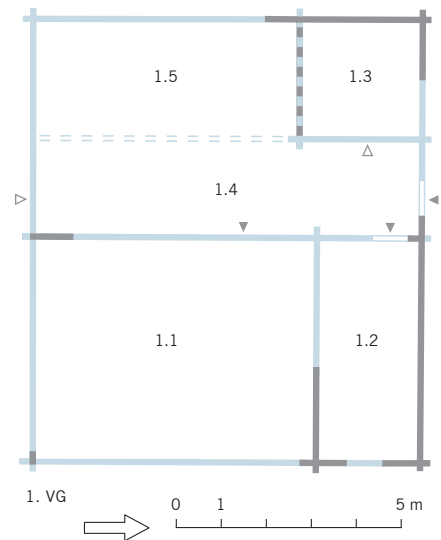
Haus Halthof in Menzingen, Grundriss des ersten Vollgeschosses.
